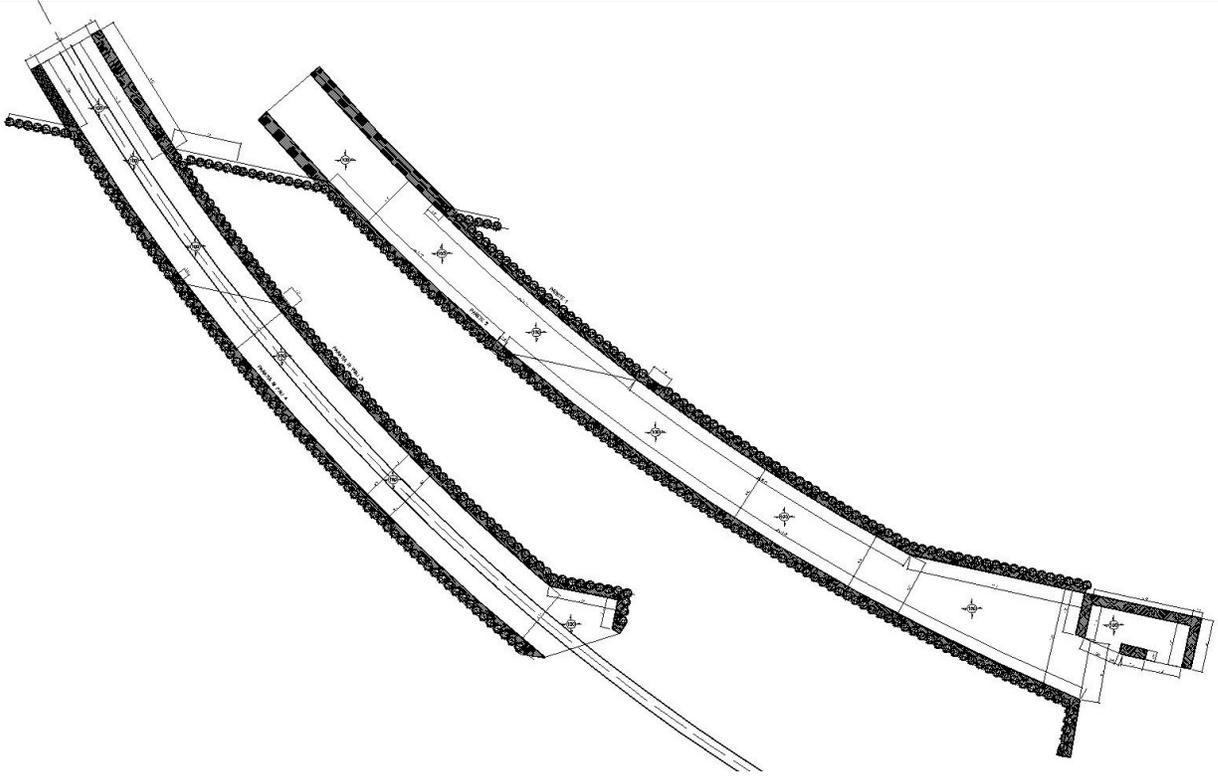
Pianta delle galleria, carpenteria solettone superiore.
